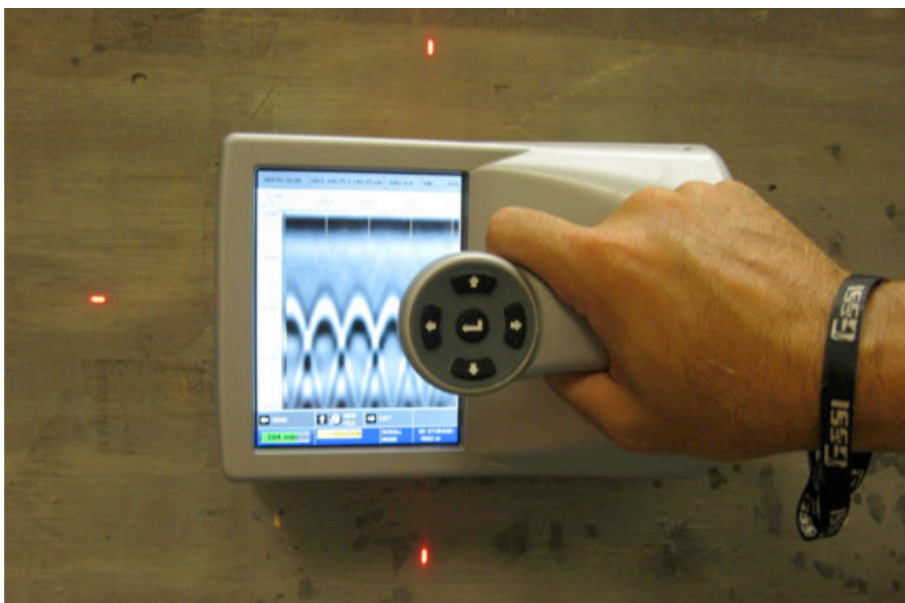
Handheld Bodenradar StructureScan Mini an einer Betonwand
